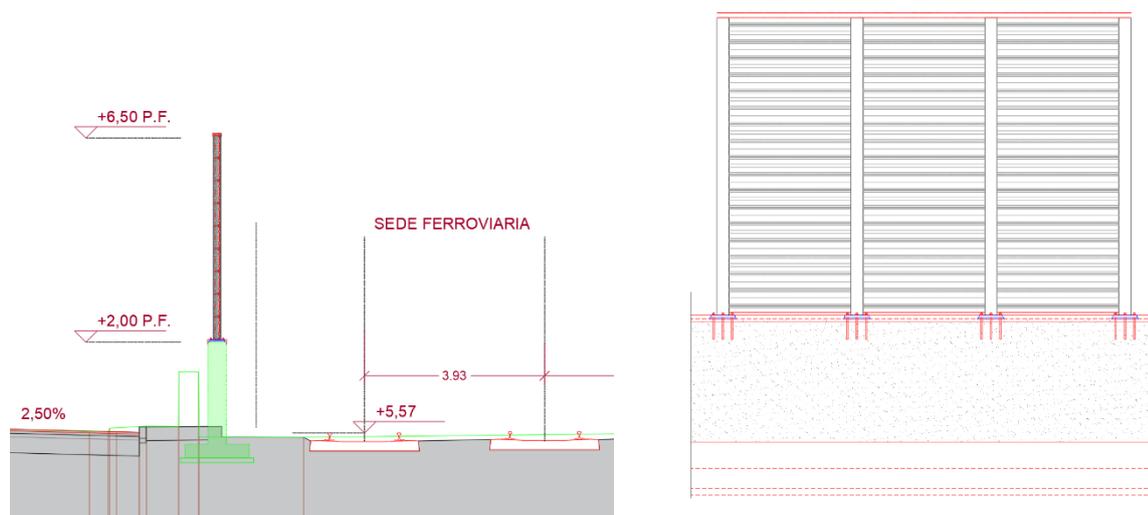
Sezione e prospetto barriera Verticale Leggera
